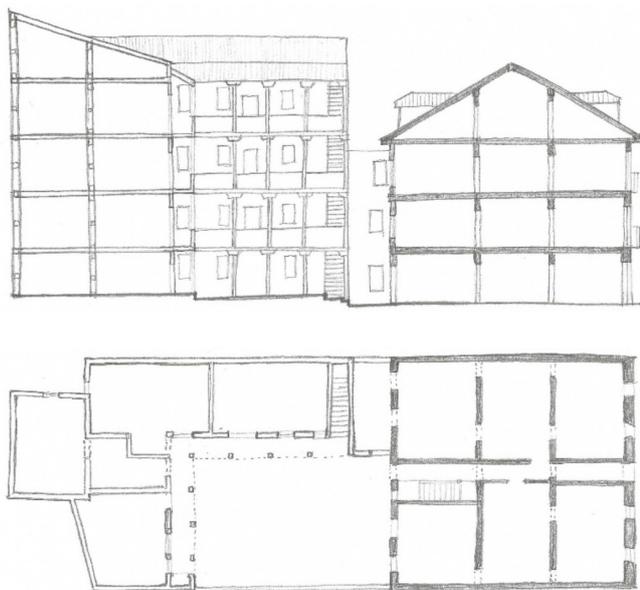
San Lorenzo 18: análisis constructivo en planta y sección (E. González-Redondo).
